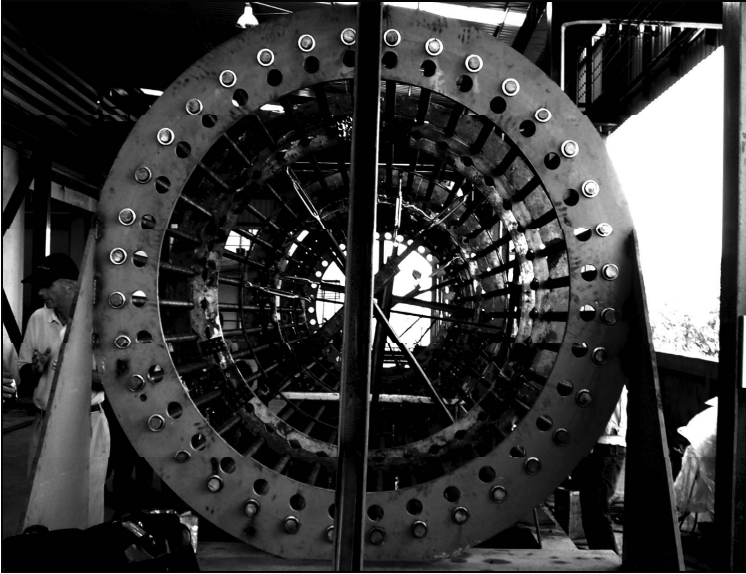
Montageschablone zur Fertigung der Bewehrungskörbe
